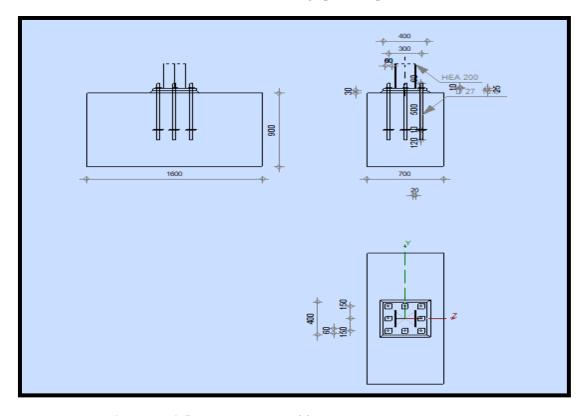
schéma d'assemblage pieds de poteau encastré.
